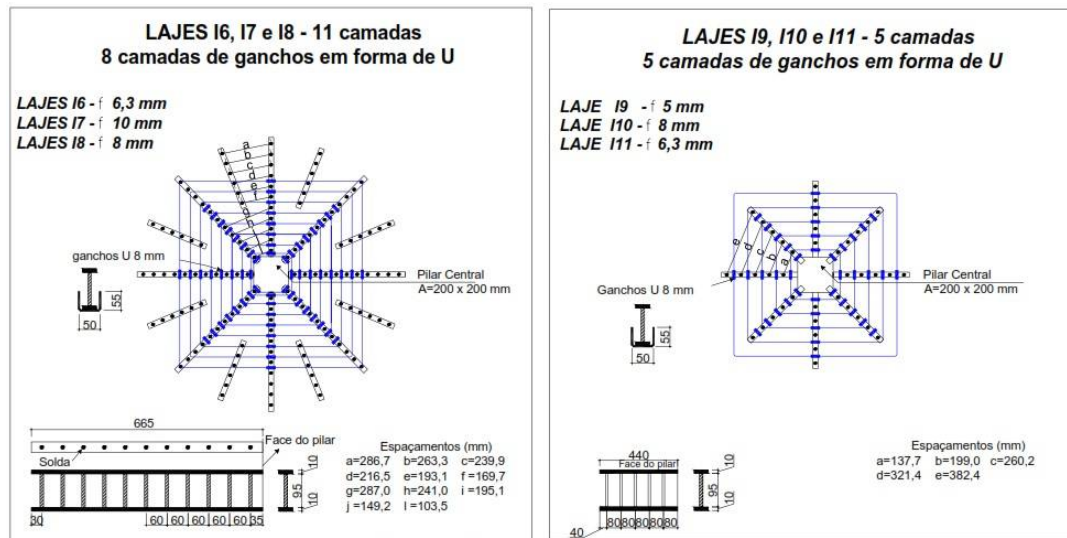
Esquema da distribuição das armaduras de punçoamento das lajes do Grupo II [69].
